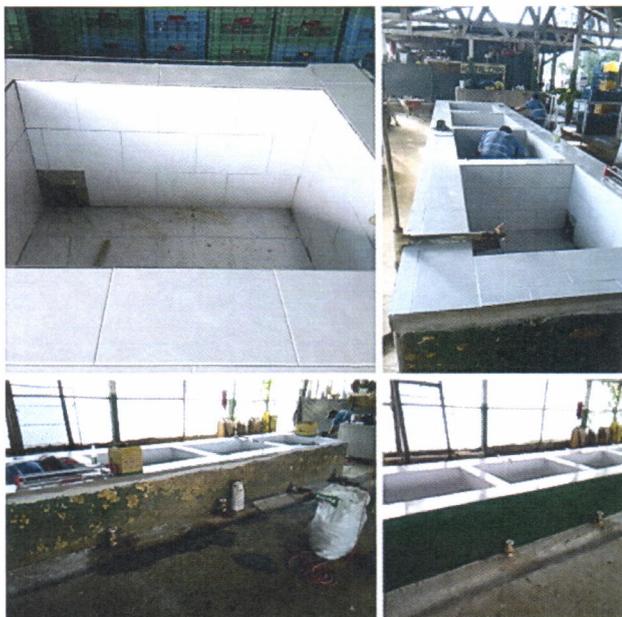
Modificación y arreglos de la pila de lavado para hortalizas.
